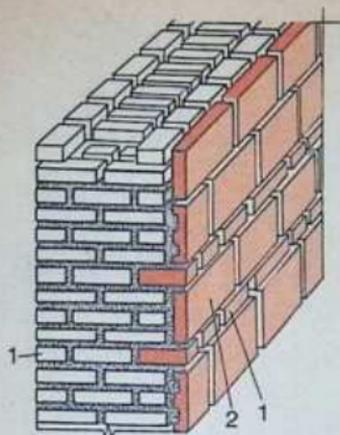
Облицовка кладки, закрепляемая прокладными плитами:
